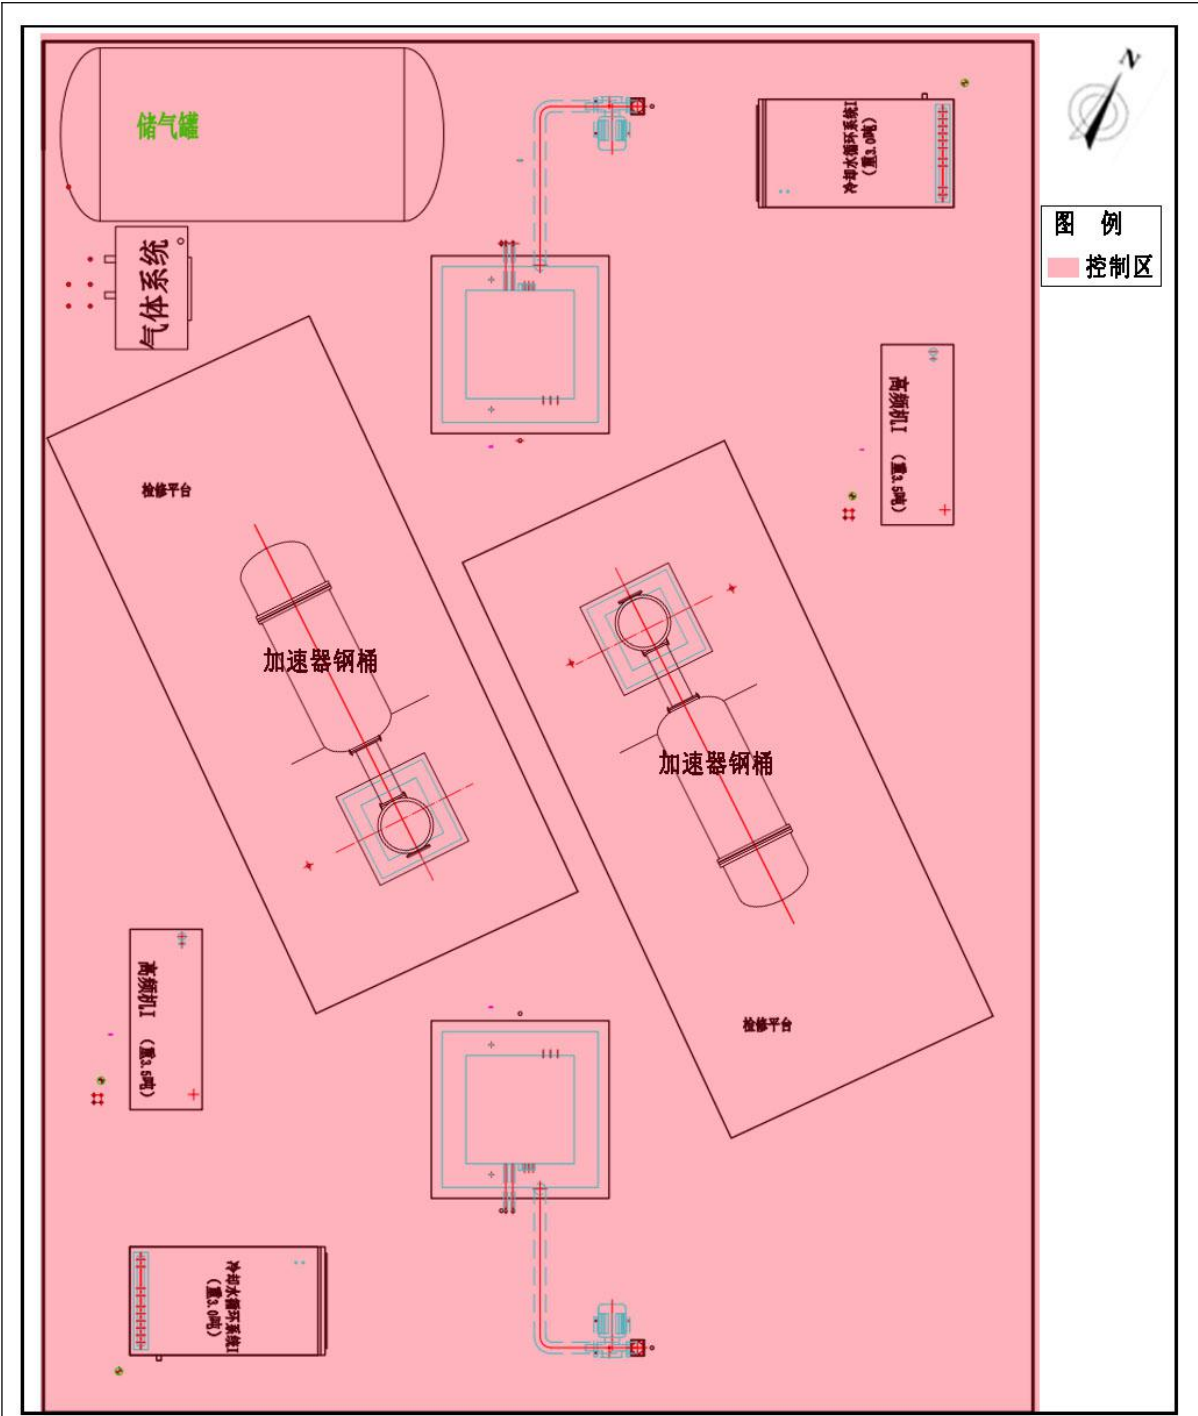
加速器室二层平面布置及控制区和监督区划分示意图
